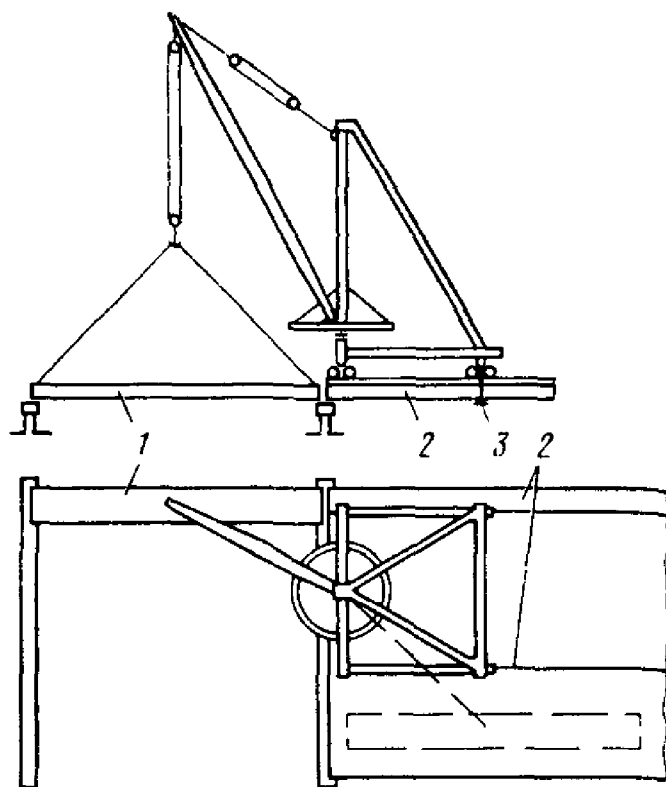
Схемы расположения деррик-крана при установке балок железобетонных пролетных строений:
